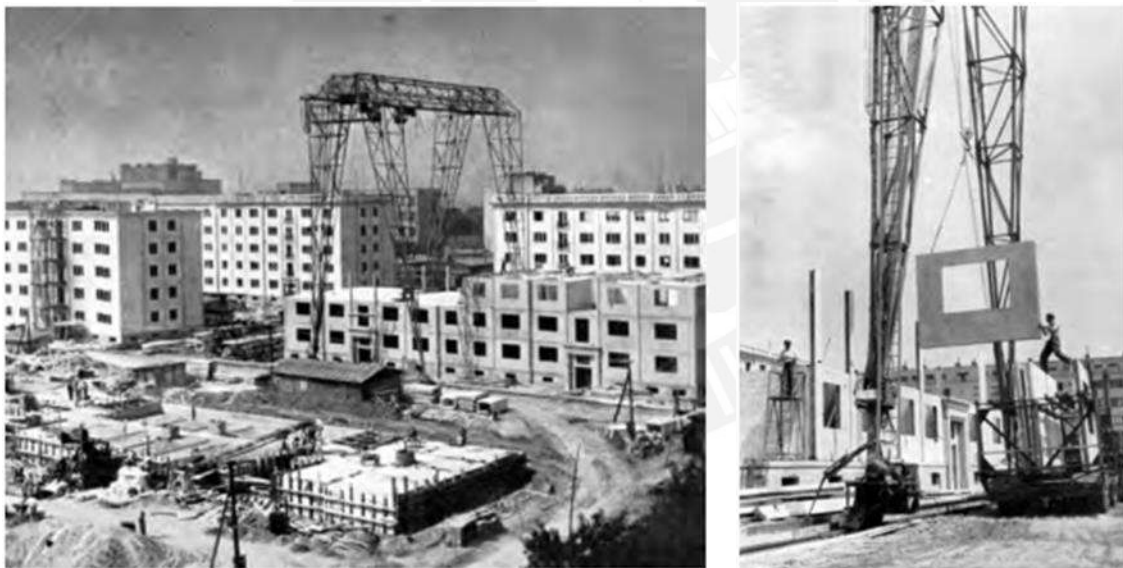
Edificio de paneles de concreto prefabricado en construcción en Praga (1956).
